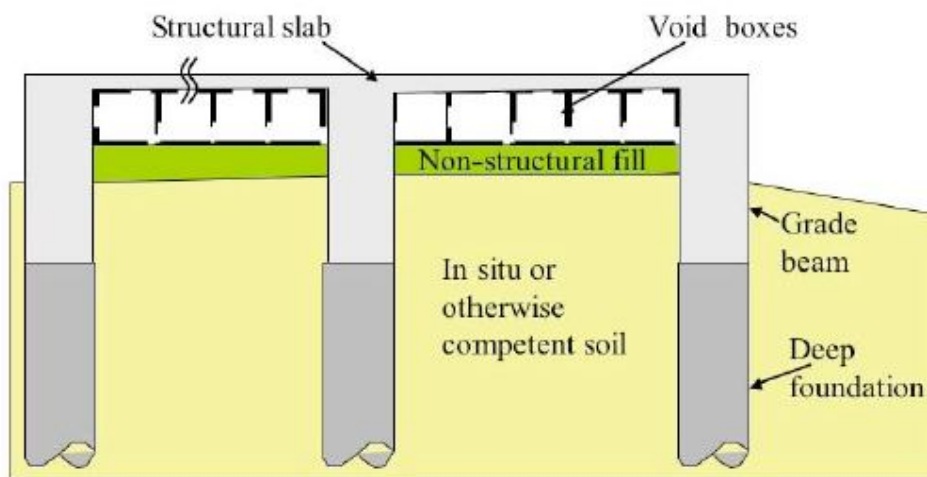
Laje estrutural reforçada com espaço livre preenchido com caixas de cartão e fundações profundas (SCFPA, 2004).
